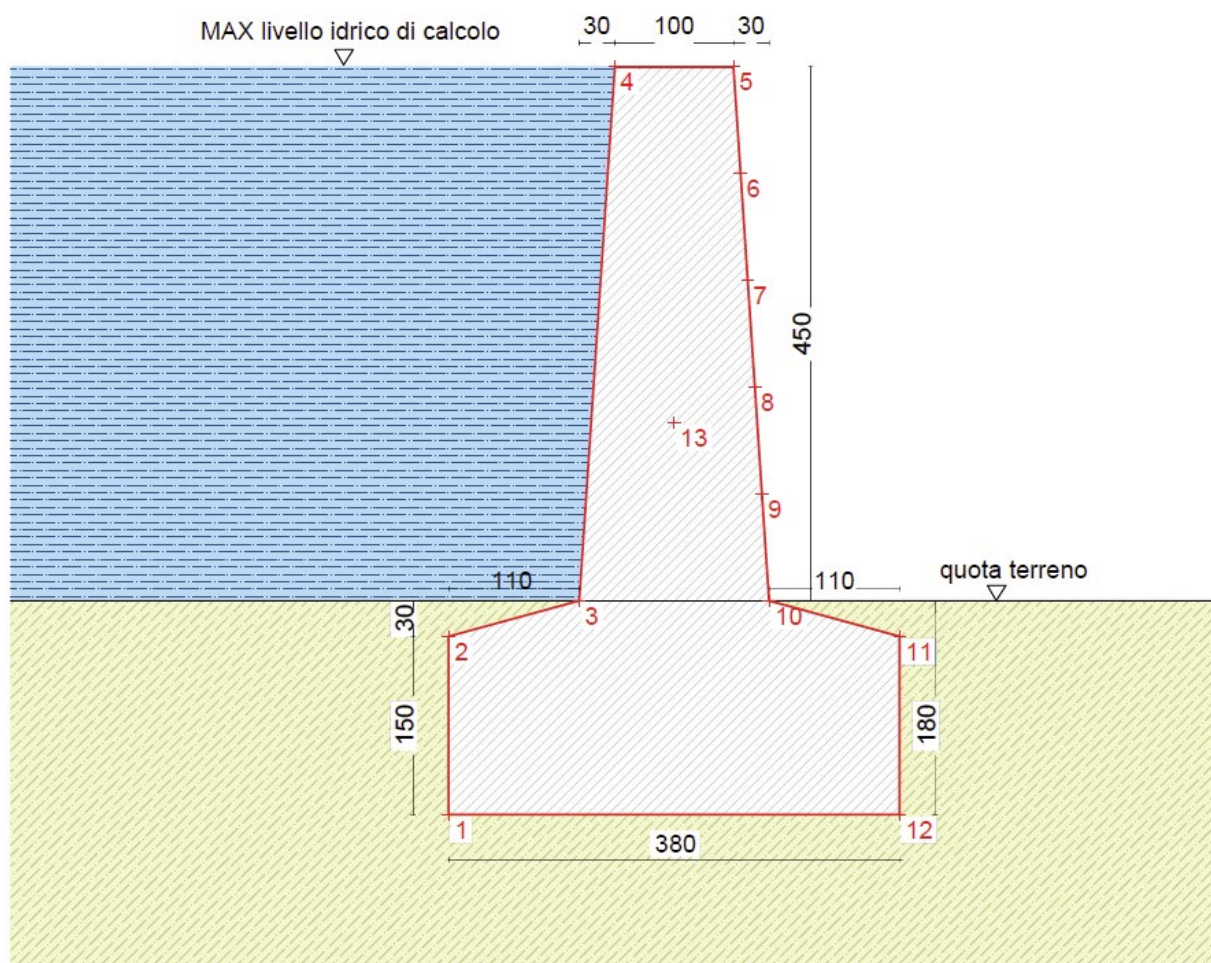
Schema muro d'argine tipo di chiusura dei varchi
